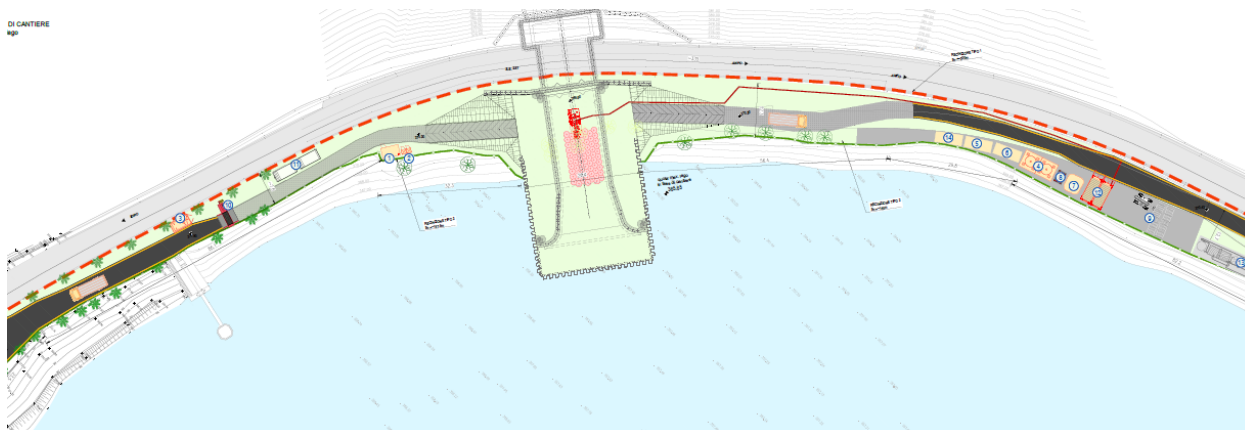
Planimetria dell'area cantiere operativo zona imbocco galleria – Fasi 5-6-7
